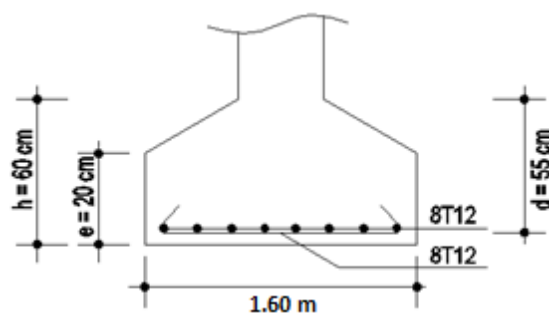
Ferrailage des semelles d'angle (HEA240).
